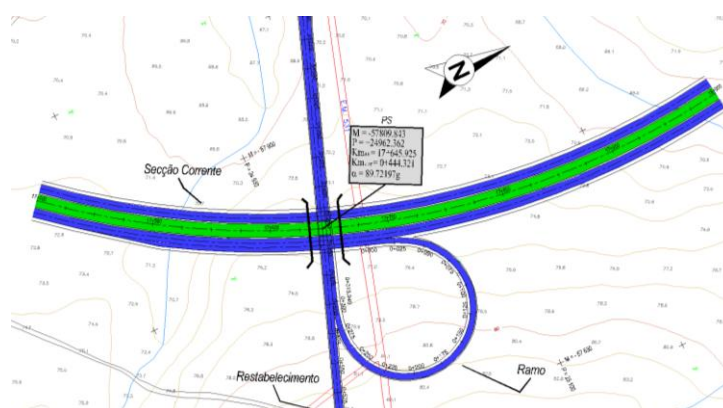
Planta Geral do Nó (solução associada a um raio de 700m)
